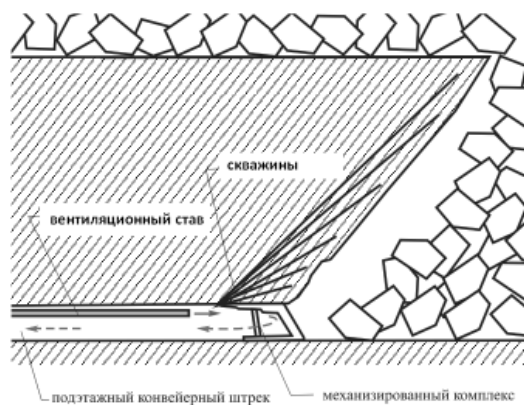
Схема отработки с подэтажной отбойкой и выпуском угля при использовании 1-го штрека в подэтаже
